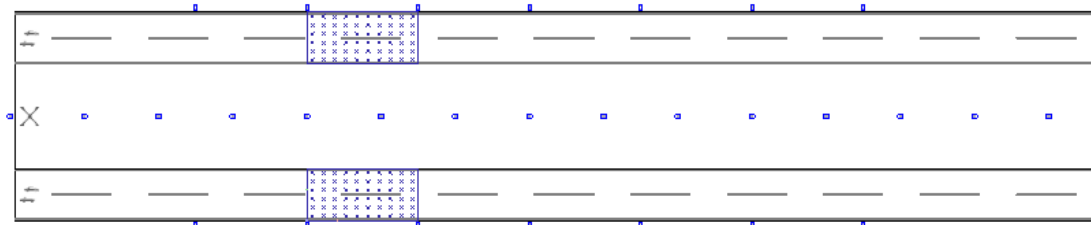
Vista en planta de la calle de acceso hacia la zona interior de la estación. Fuente: Dialux
